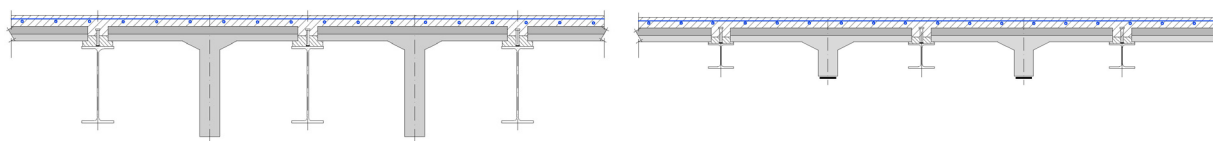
Secciones tipo de vigas π_i de diferentes cantos reforzadas sin y con fibra de carbono
